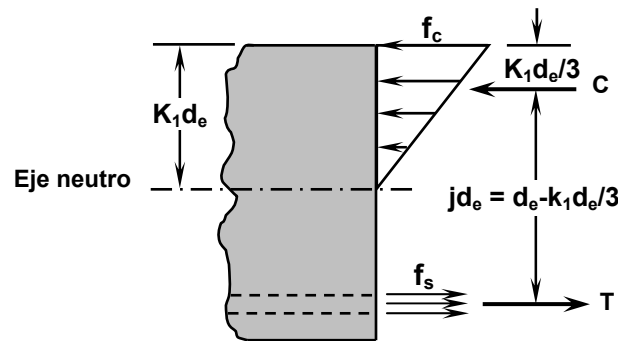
Sección fisurada de un elemento sometido a flexión.
